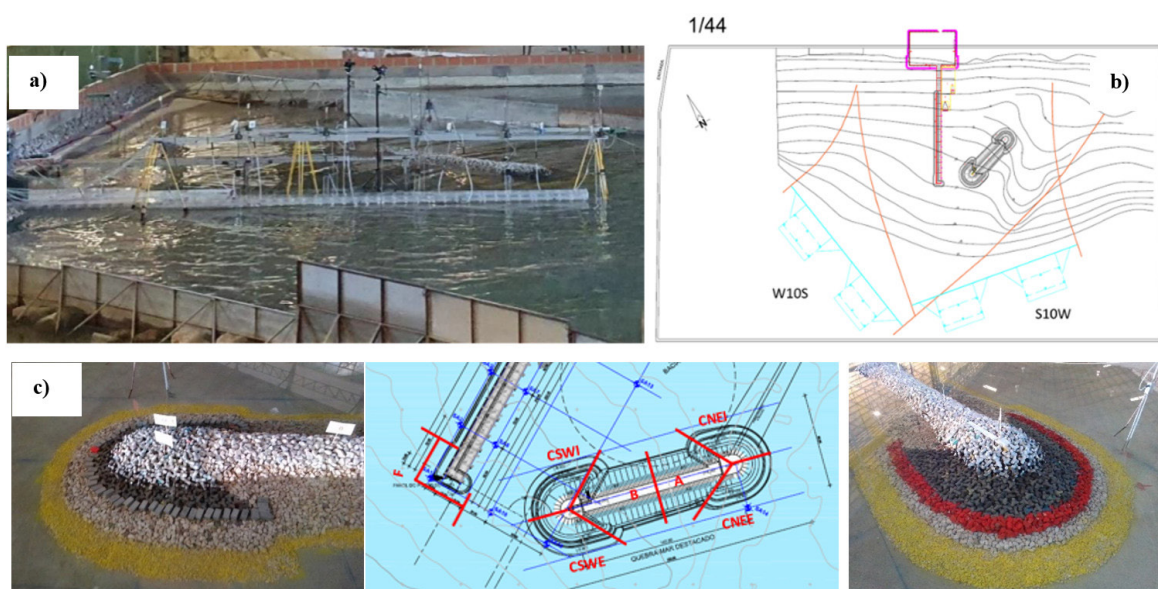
Vista geral do modelo físico (a). Batimetria e esquema da implantação (b). Quebra-mar destacado (c)
